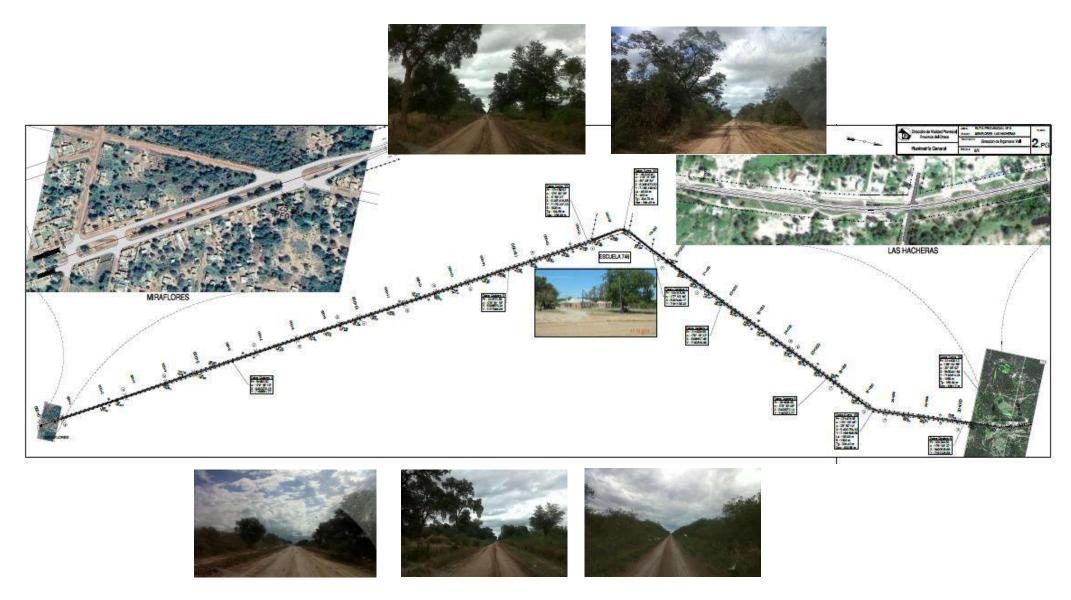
Planimeria General de Proyecto- Fuente: Estudio de Ingeniería
